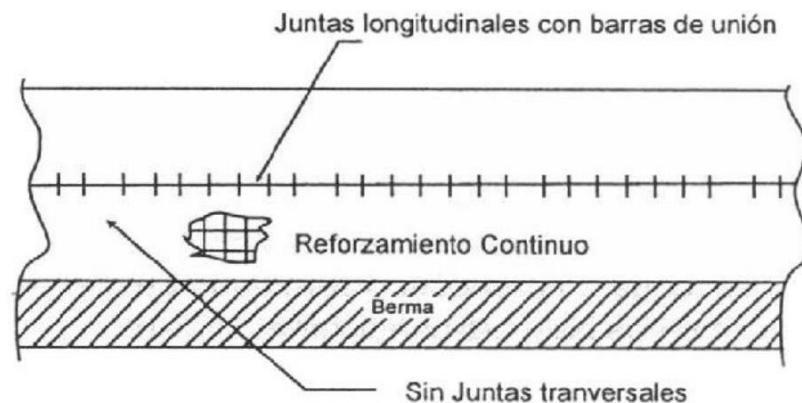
Composición de un pavimento continuo de concreto reforzado (Fuente: Menéndez (2012))
